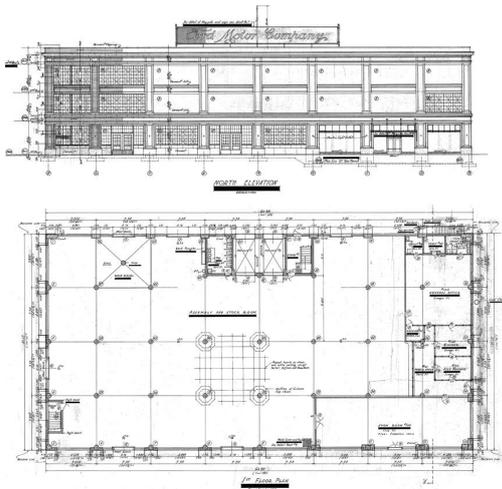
Fachada principal da Rua Solon e planta baixa do primeiro pavimento. Fonte: Acervo da Biblioteca Histórica Bentley, Universidade de Michigan.
